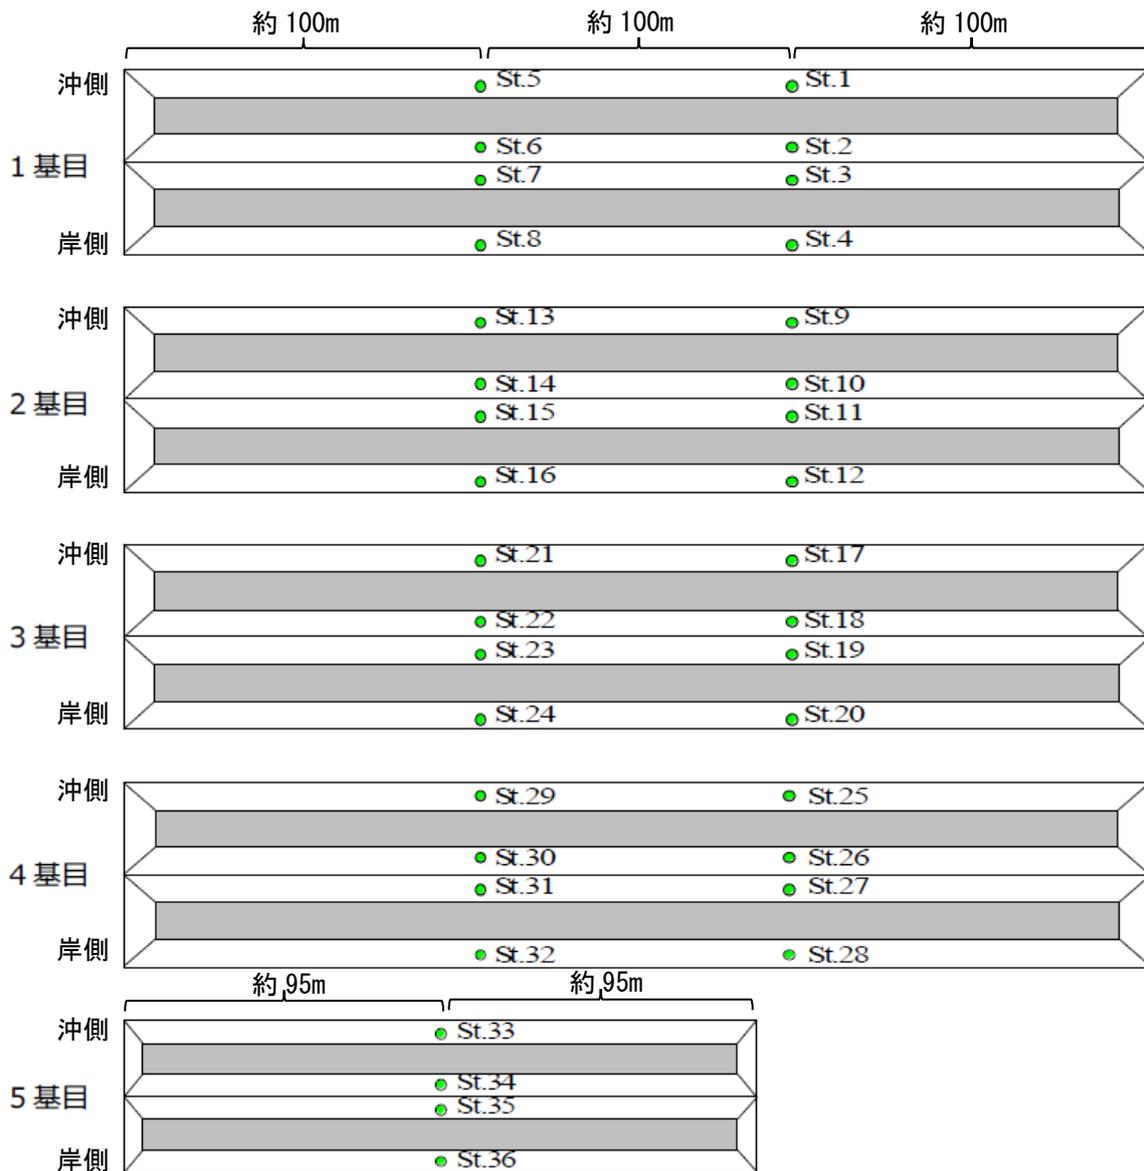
付着状況調査地点 (平面図 : 1 基目~5 基目)
